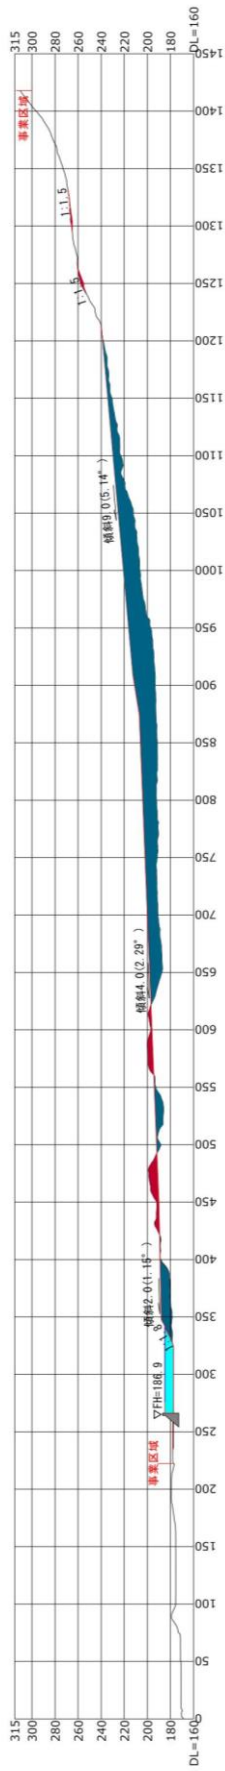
(1) 切土・盛土計画断面図 (E1-E1' 断面)
